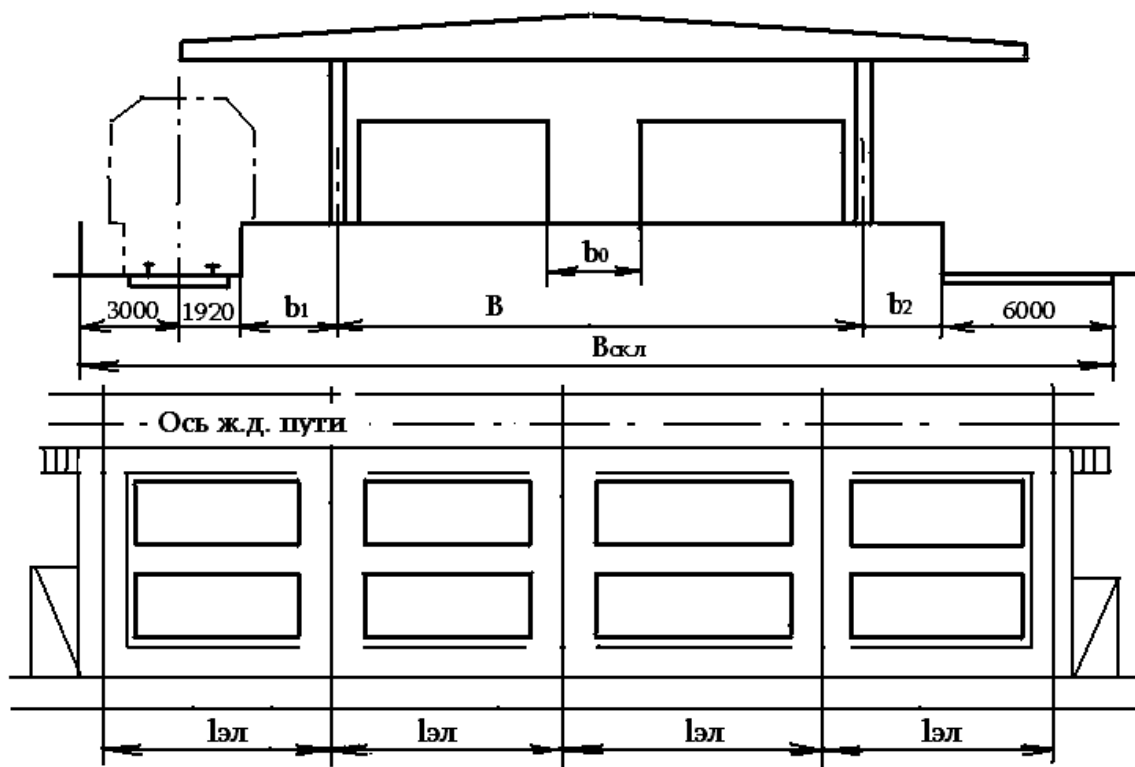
Схема склада тарно-штучных грузов с компоновкой элементарных площадок в плане
